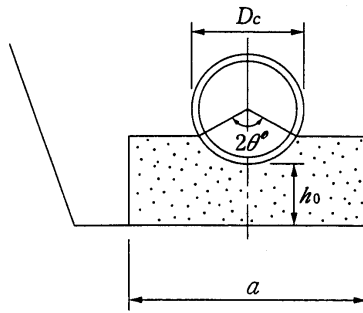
コンクリート基礎の形状（半巻き基礎）
